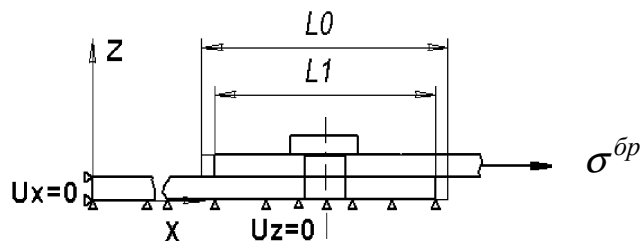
Розрахункова схема одноболтового двозрізного з'єднання
